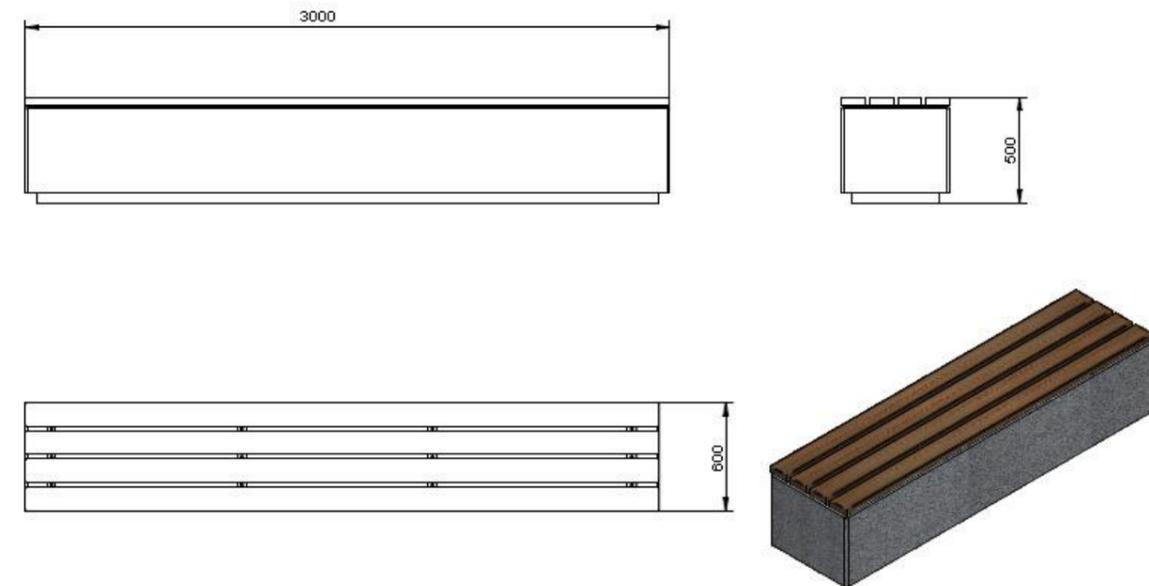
Vistas banco tipo 1 en la plaza al norte de la estación. Fuente: Benito.com.
